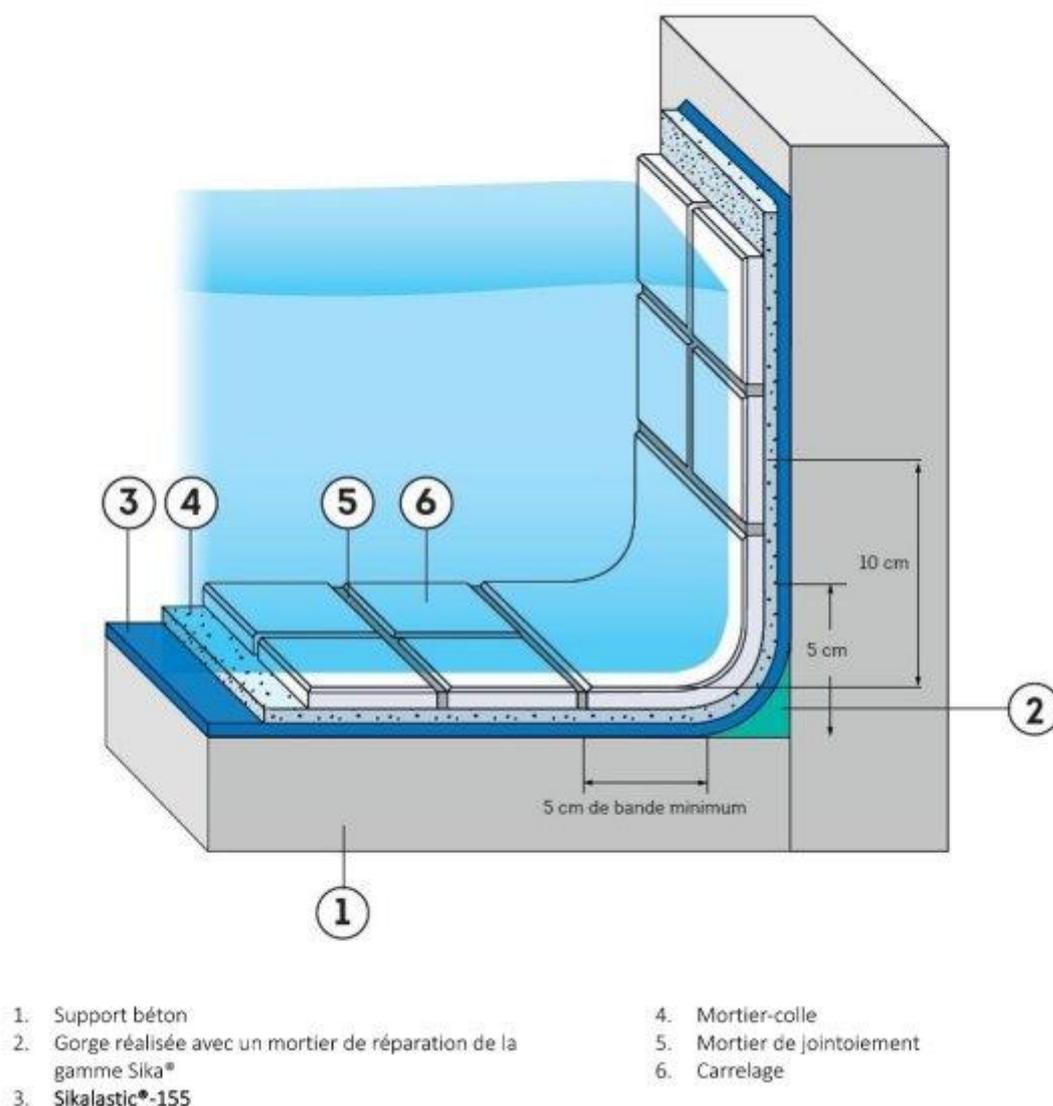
Traitement d'une remontée fond de bassin - paroi
